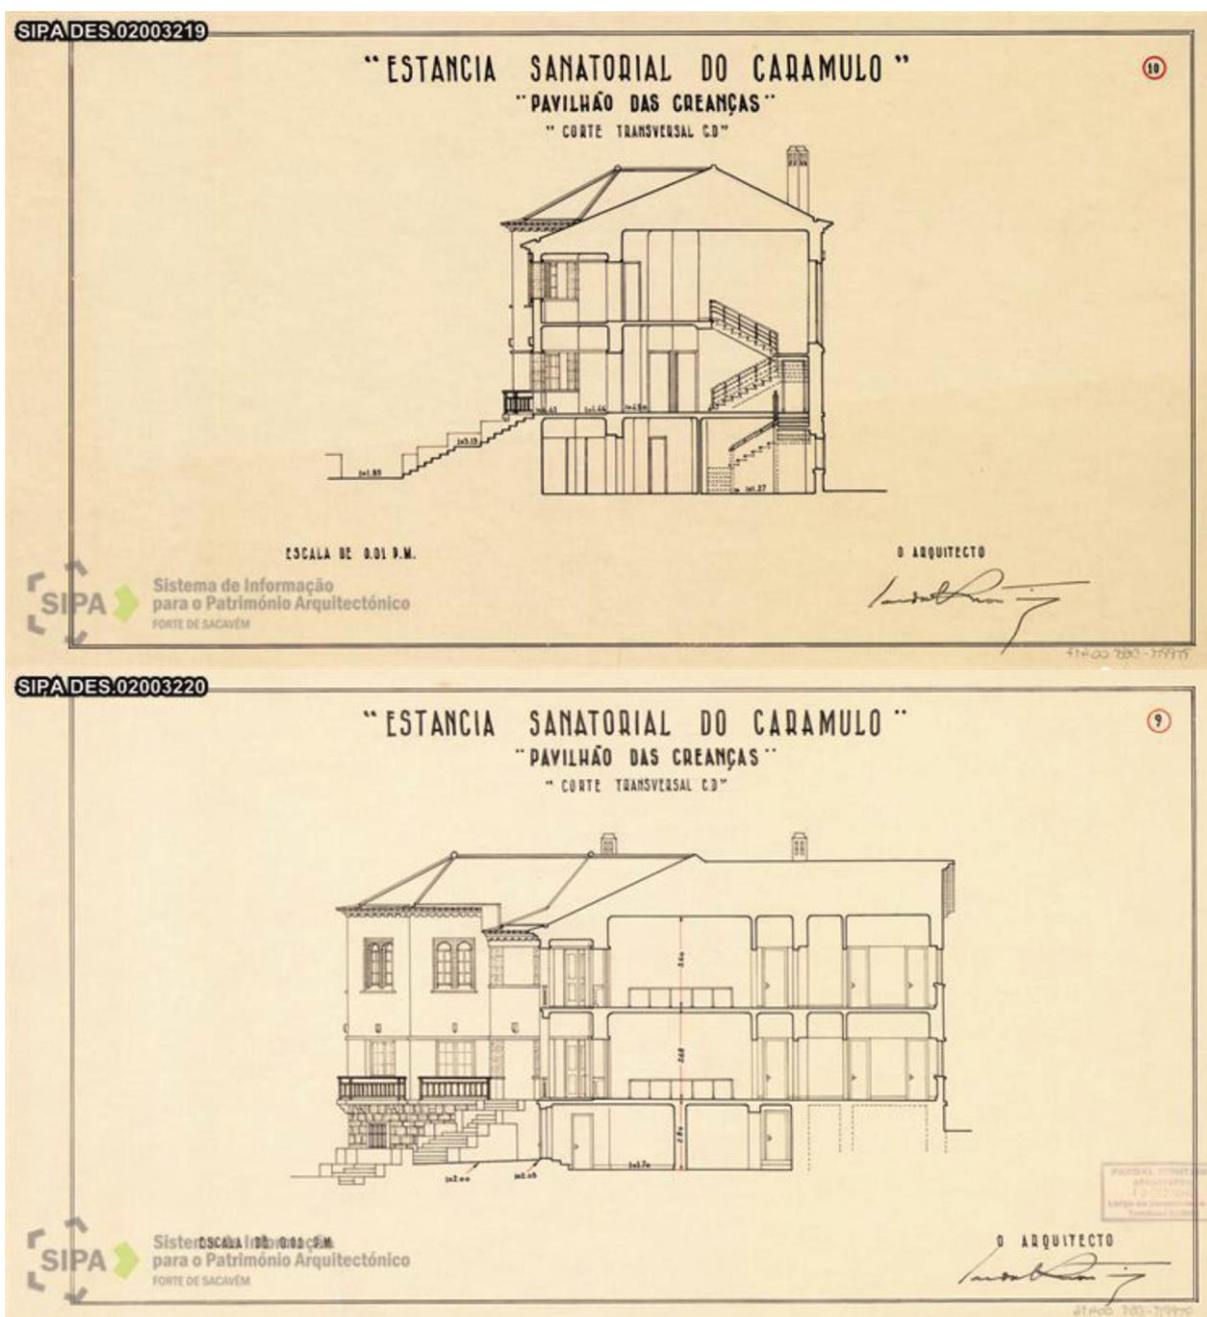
Cortes CD – projeto de Pardal Monteiro
